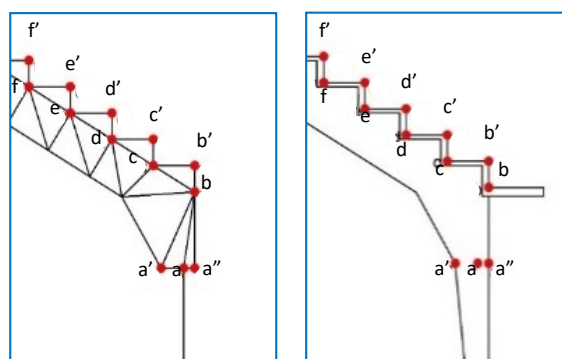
Particolare della modellazione del telaio tipo 1, con dettaglio dei collegamenti fra travi e pilastri
